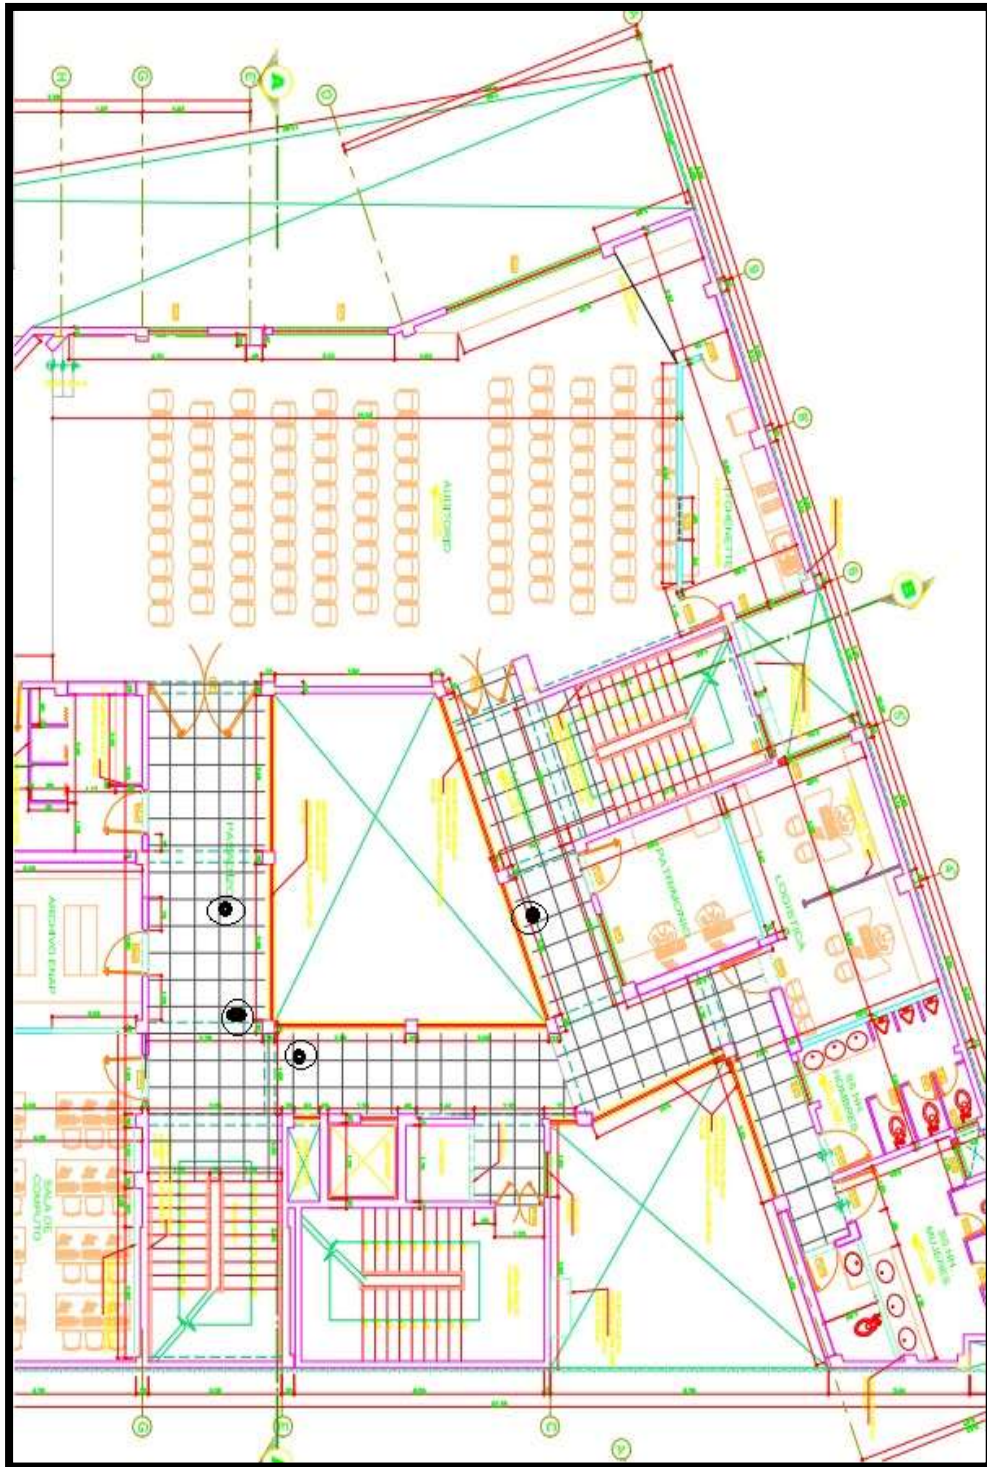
Plano de distribución de oficinas Piso 4 sede ENAP.
